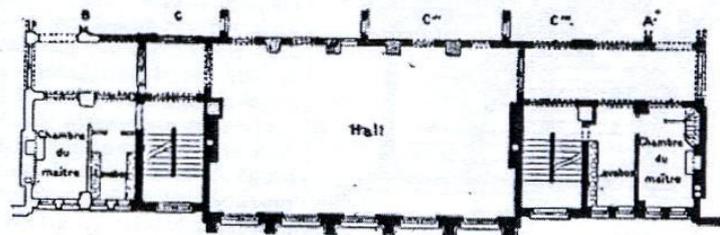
Ivydale road à Londres. — Plan par étage.
